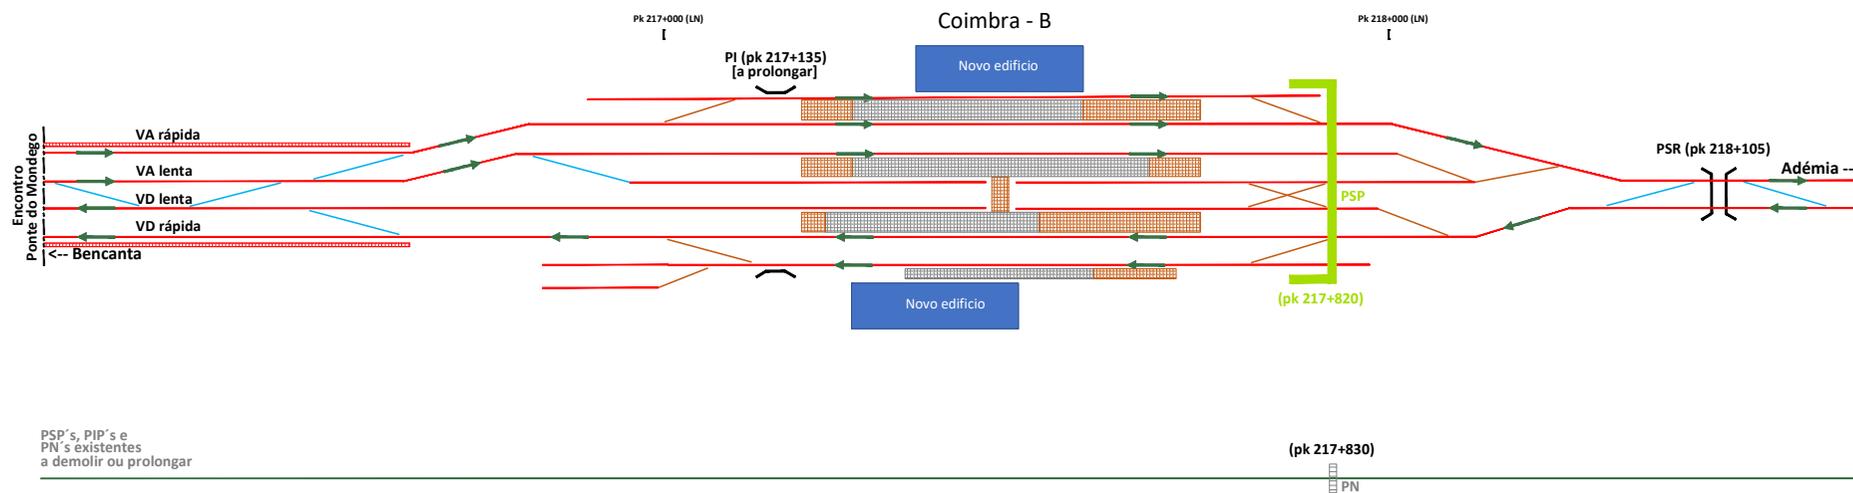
Esquema de Localização das Obras de Arte na zona da Estação de Coimbra B
